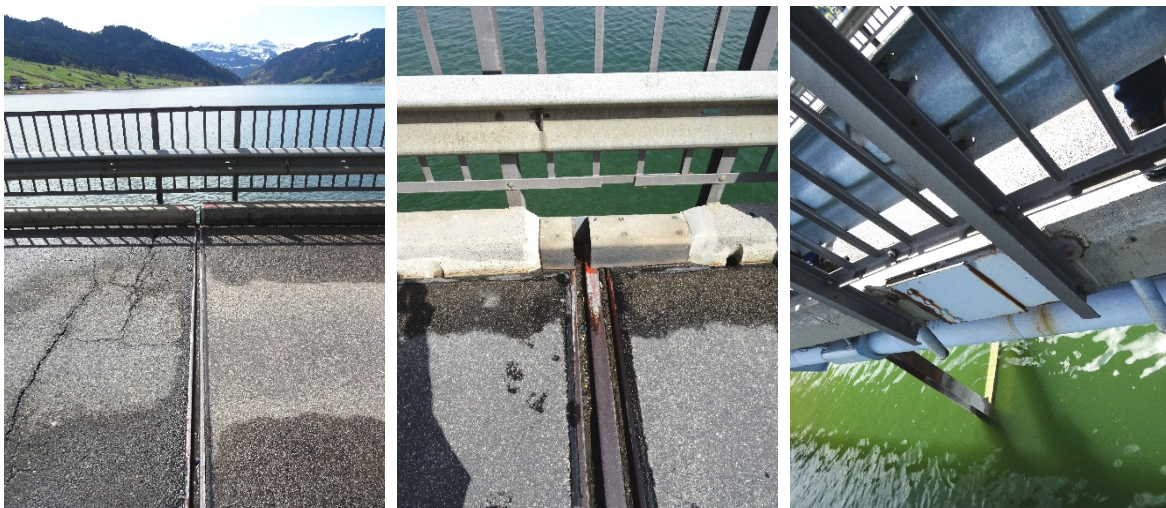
Fugenkonstruktion des Gerberträgers: fixiertes Gelenk (links) mit einem Fugenband und bewegliches Gelenk (Mitte) mit zwei Fugenbändern zwischen Stahlbauteilen; Randabschluss mit Blechabdeckung (rechts) beim beweglichen Gelenk. (Fotos: 6. Mai 2017)
